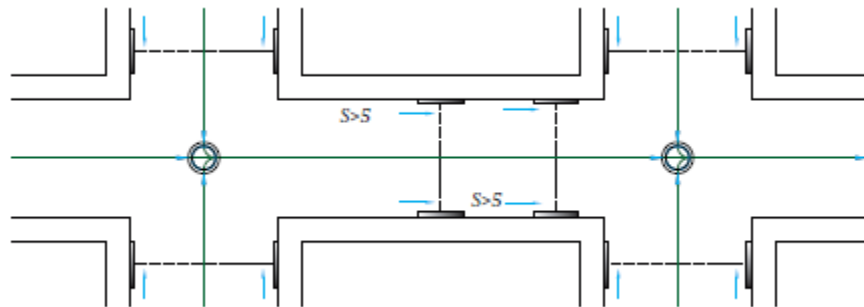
Ubicación de coladeras longitudinales de banqueta. Fuente: CONAGUA, 2015.
